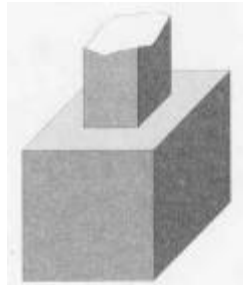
Fundação tipo bloco (Lustosa, 2018)
